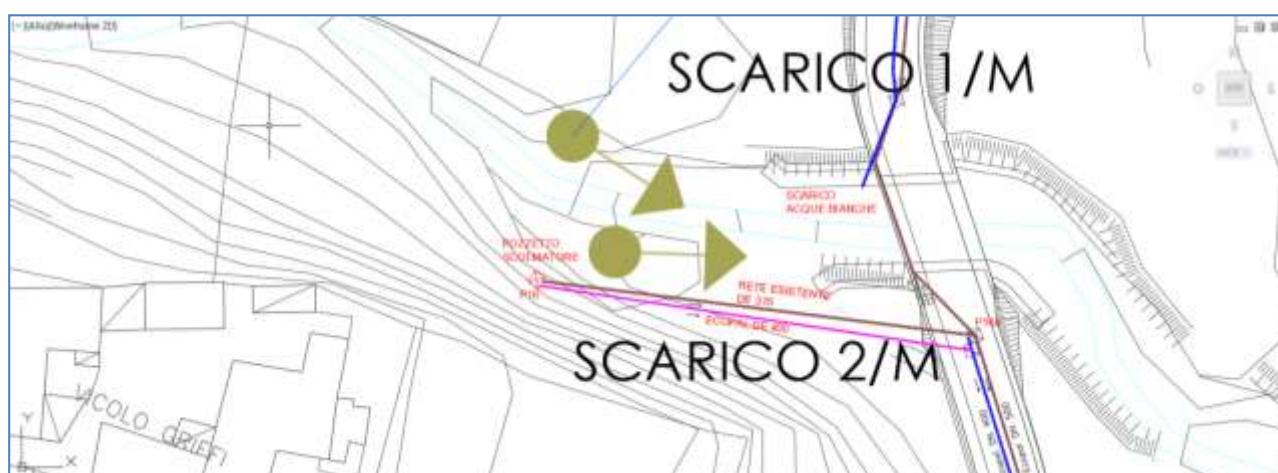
STRALCIO PLANIMETRIA DI PROGETTO: in fucsia nuova rete bianca, in marrone nuova rete nera
